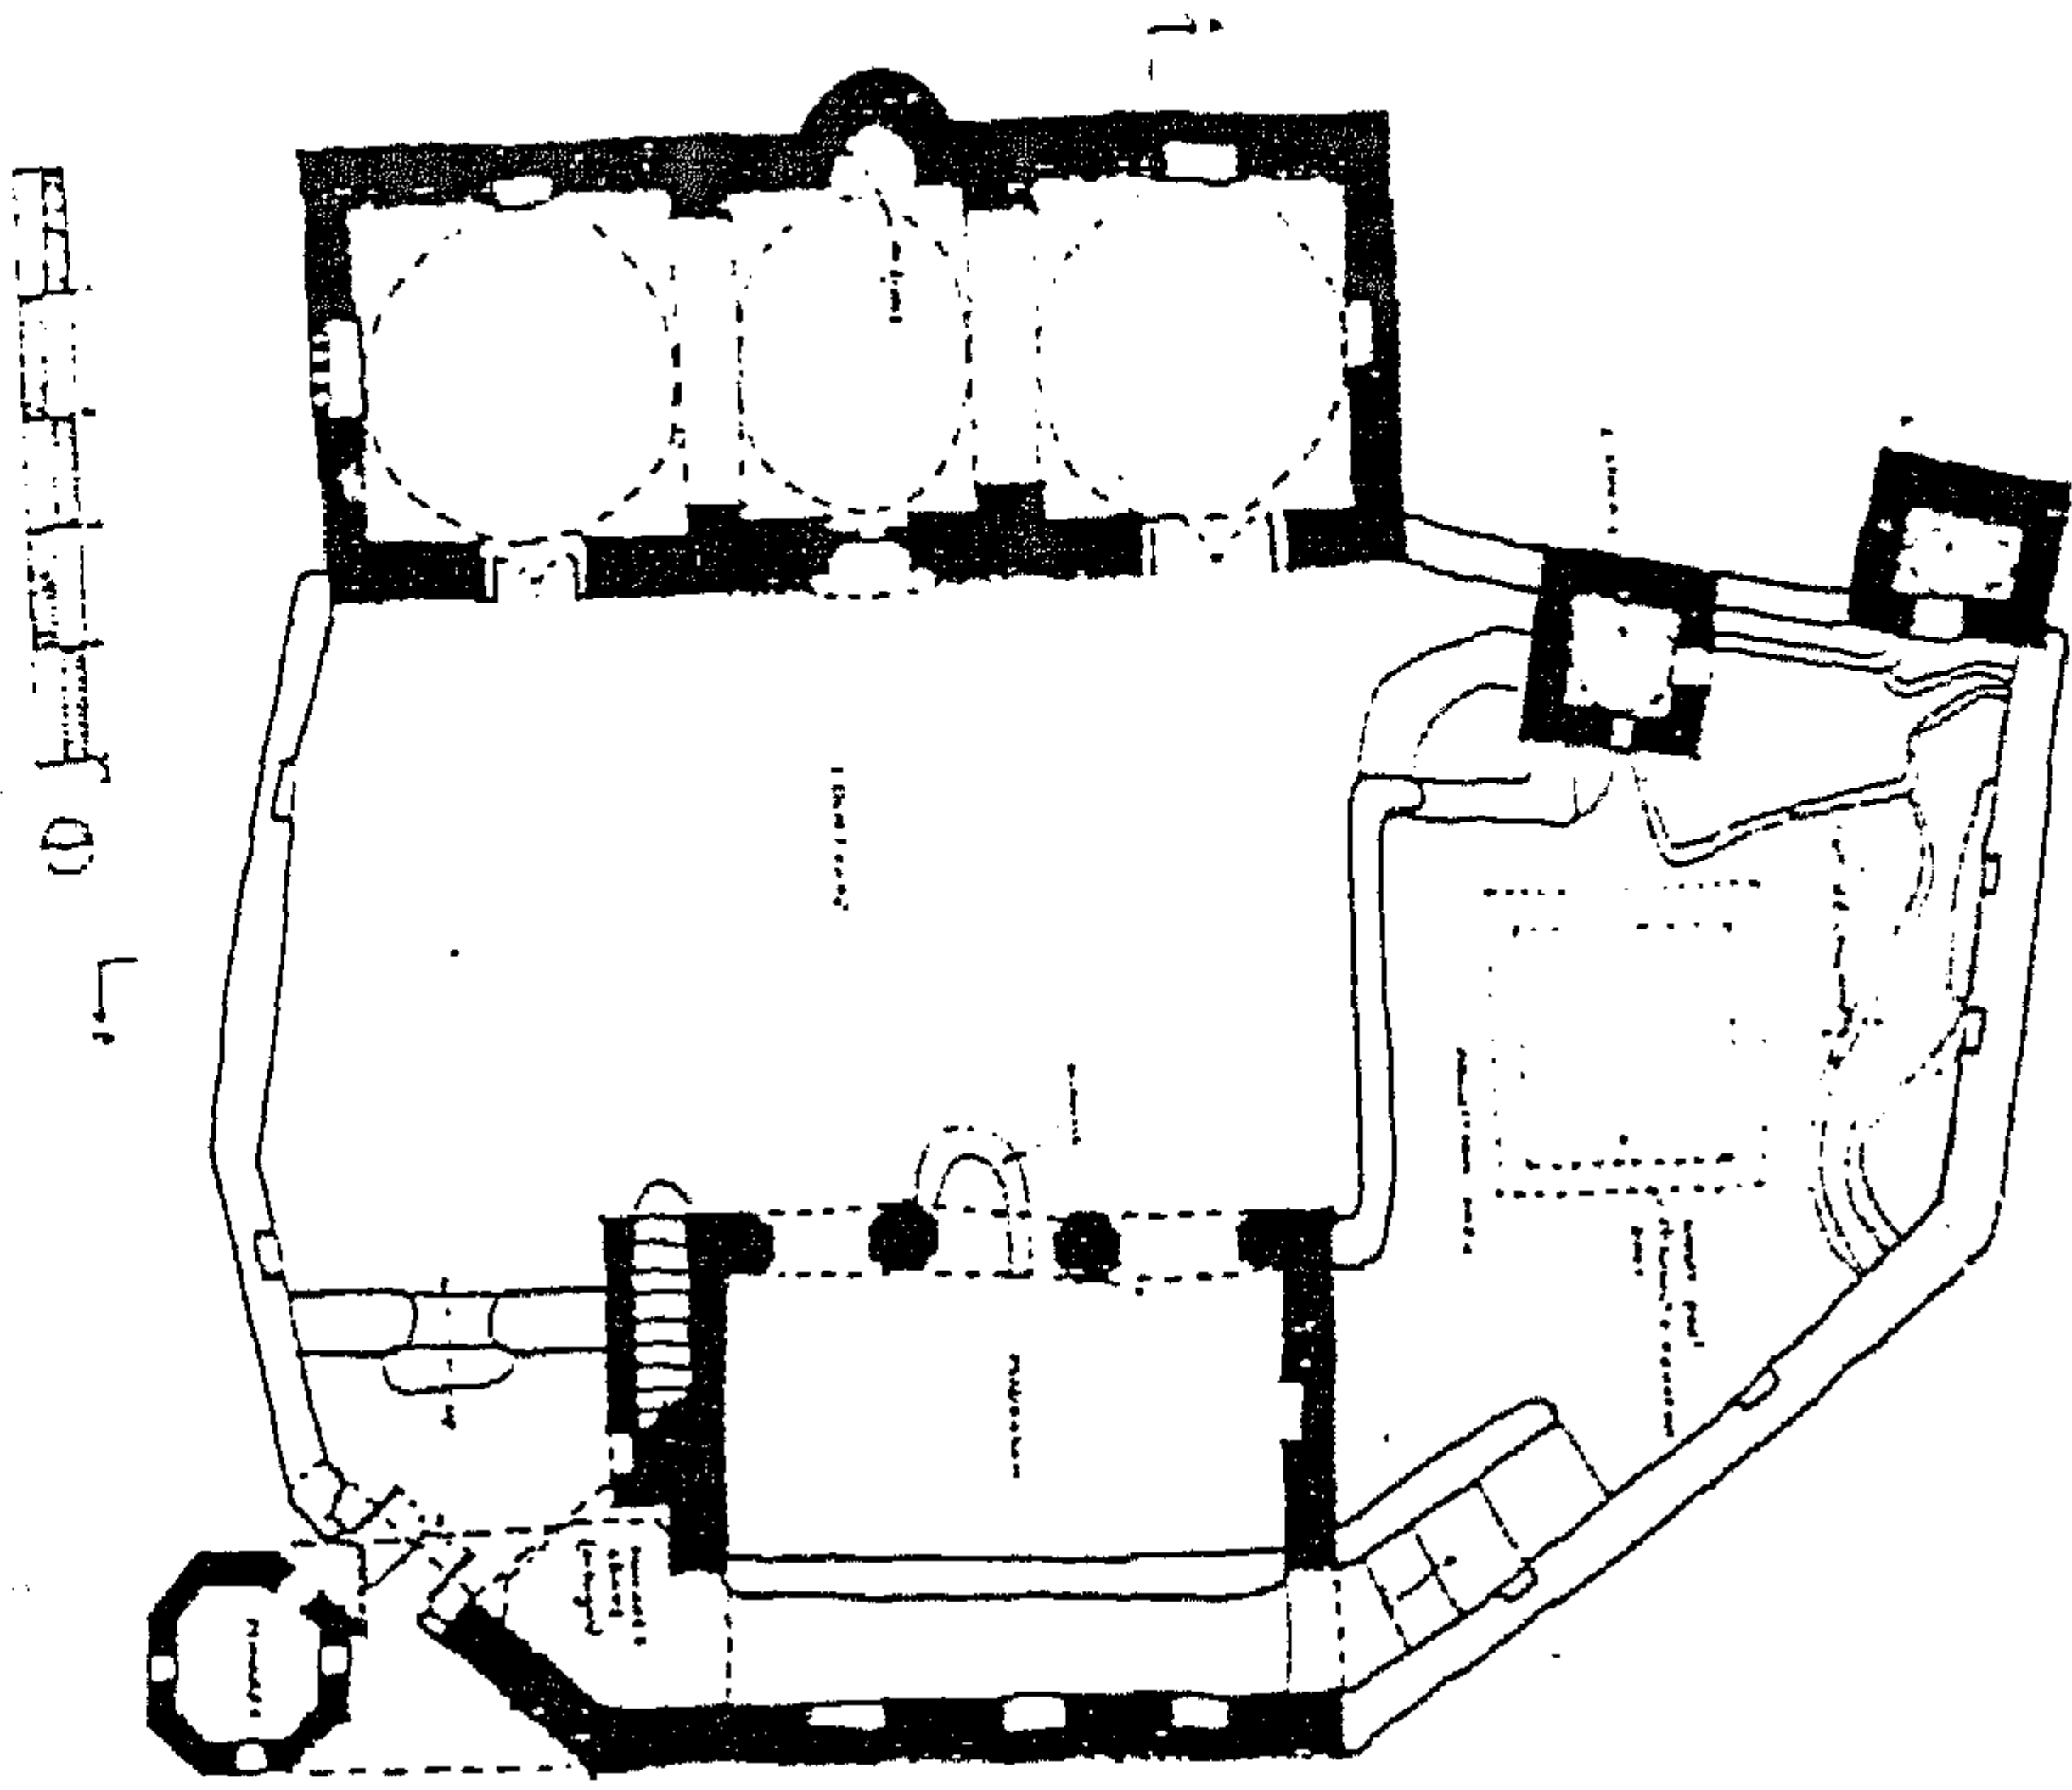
زبيد ، مدرسة المزدجاني ، المسقط الأفقي
